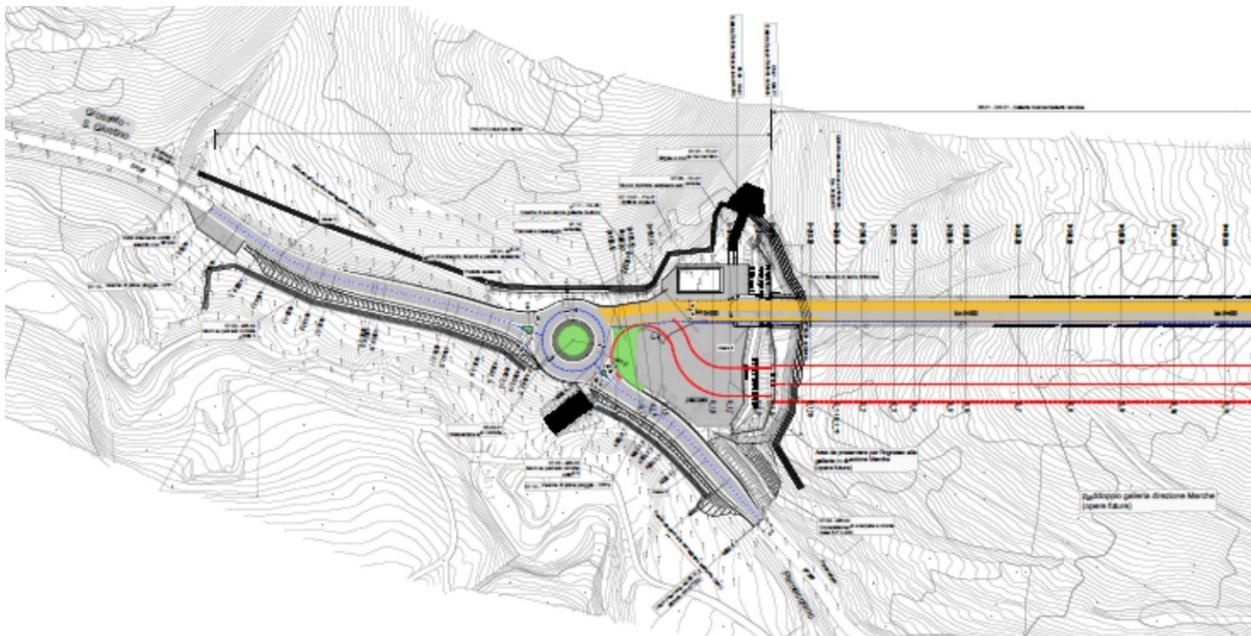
Planimetria dell'intersezione sul lato umbro della Galleria della Guinza (Rotatoria 1)
